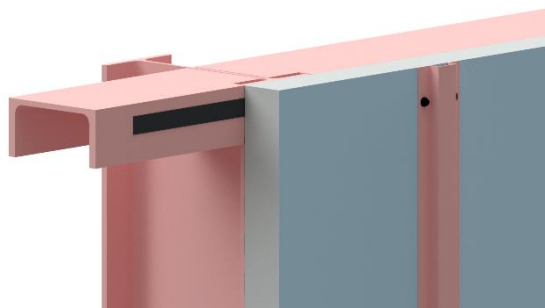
Schéma de principe en zone sismique du fractionnement d'un double réseau avec panneaux sandwich isolants posés verticalement au droit des planchers
